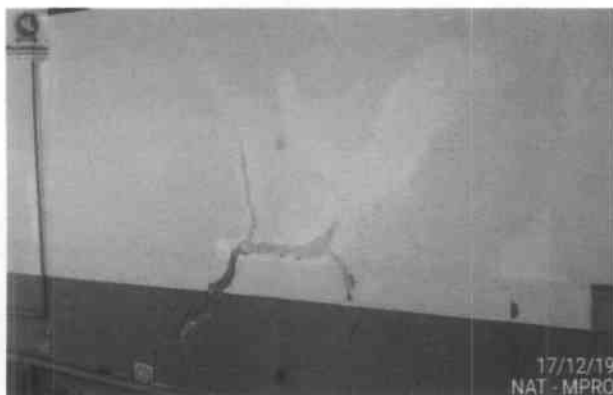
Pavilhão vivência – trincas por diversas paredes.
